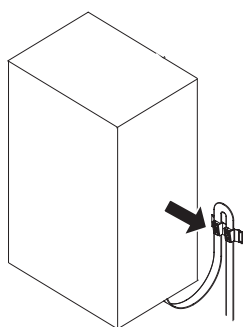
Staffa di fissaggio del cavo pensile di mezza corsa
